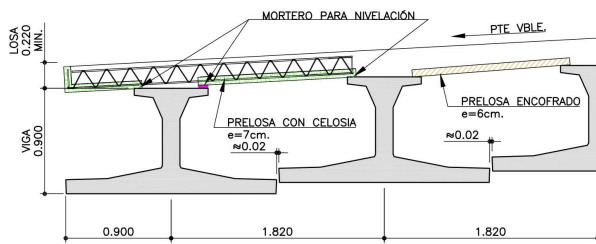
Disposición vertical de vigas en perfil longitudinal en pendiente
